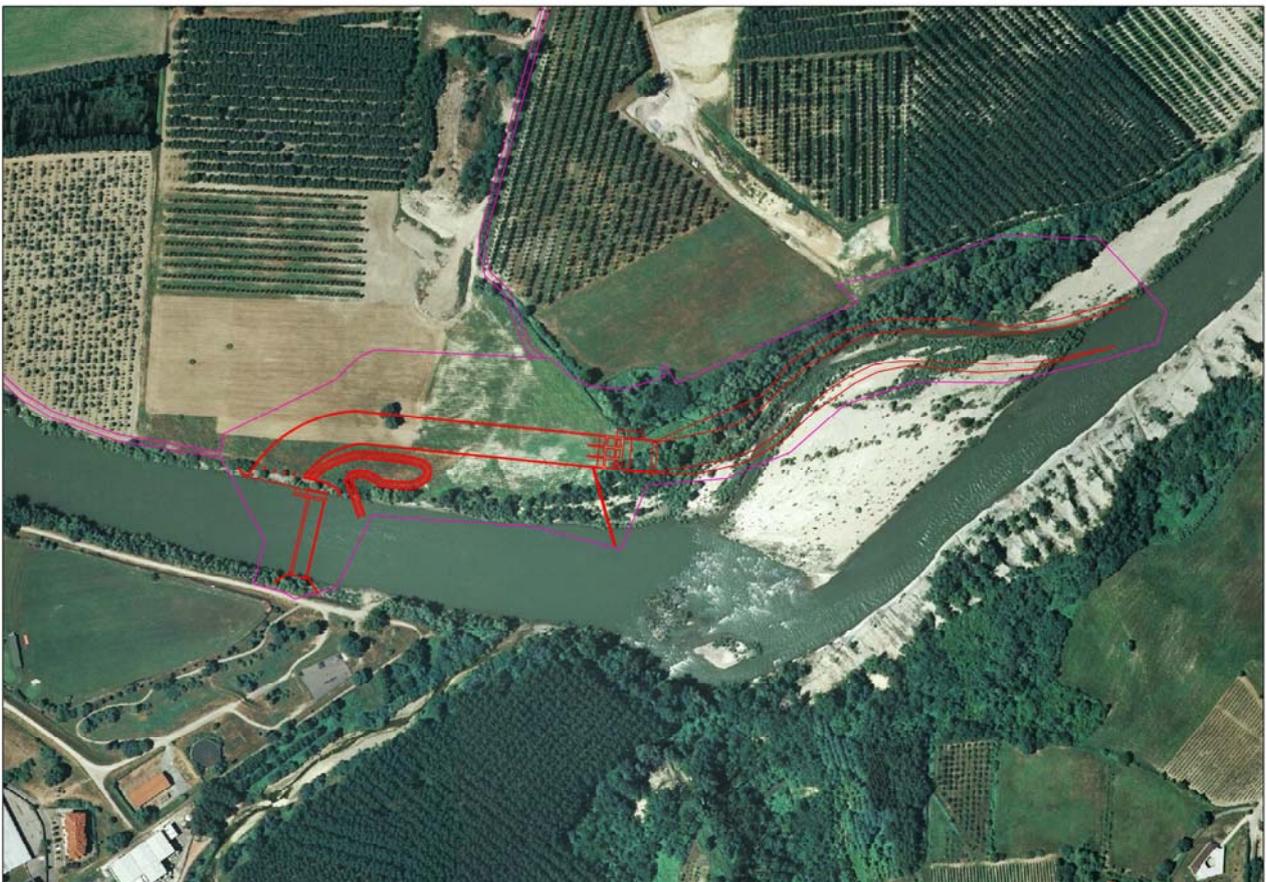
Individuazione delle opere a progetto (linee rosse) e dell'area di cantiere e della viabilità (linea magenta)
